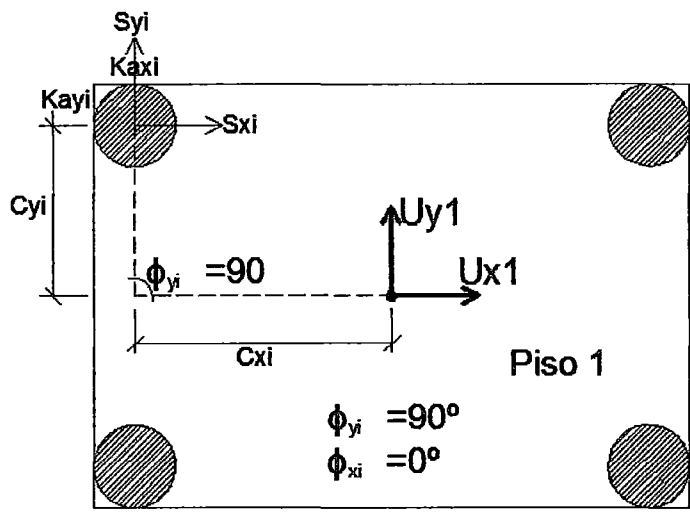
Orientación de la columna en el sistema de coordenadas.
